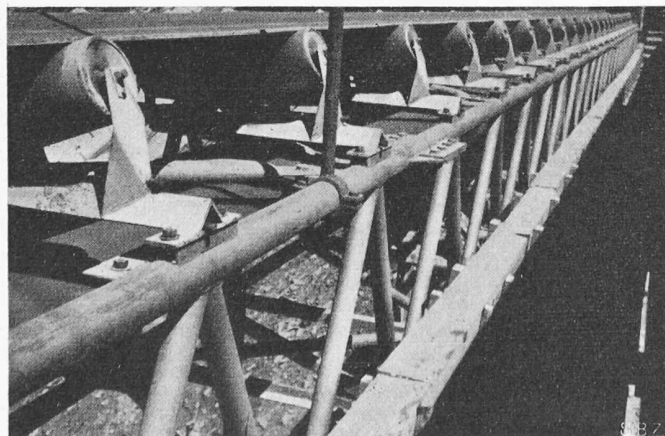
Detail mit Gurtstoss, vom innern Laufsteg aus (im Vordergrund Holzabdeckung für elektrische Kabel)
